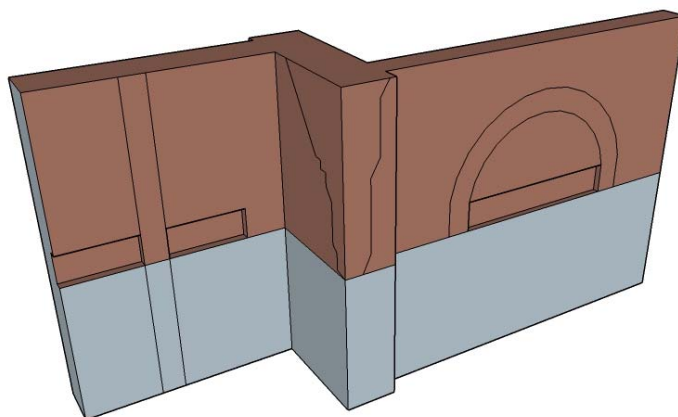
Inicio fisura por asentamiento. Fuente propia.
